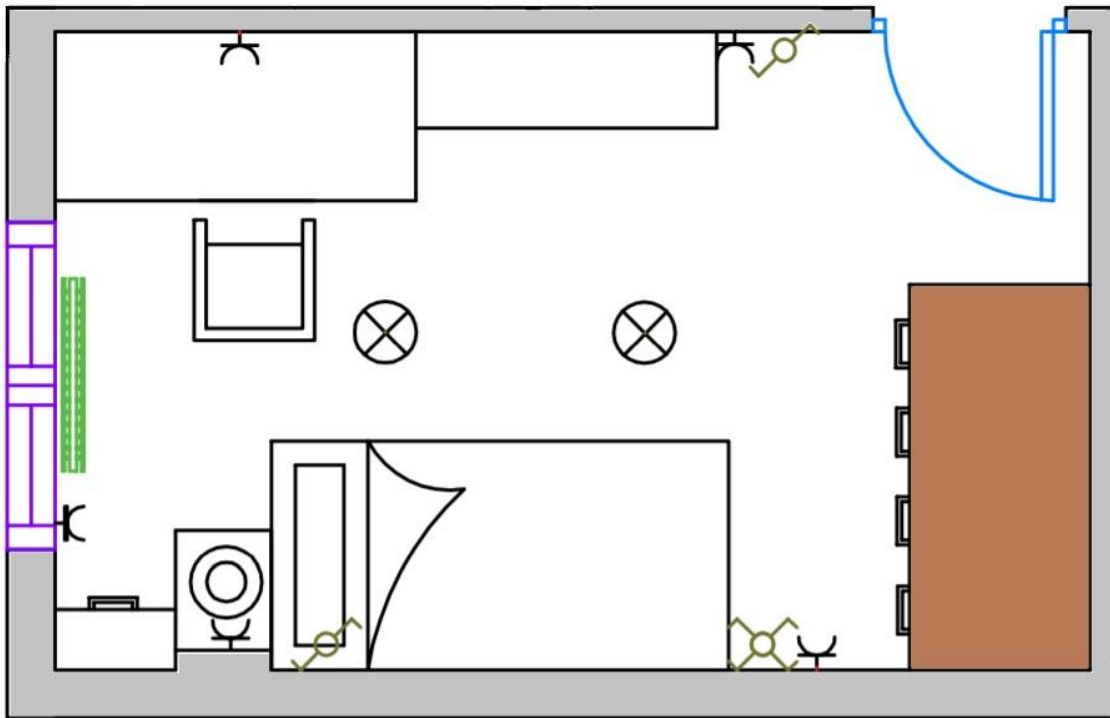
Plano de planta del dormitorio 2. Fuente: Elaboración propia
